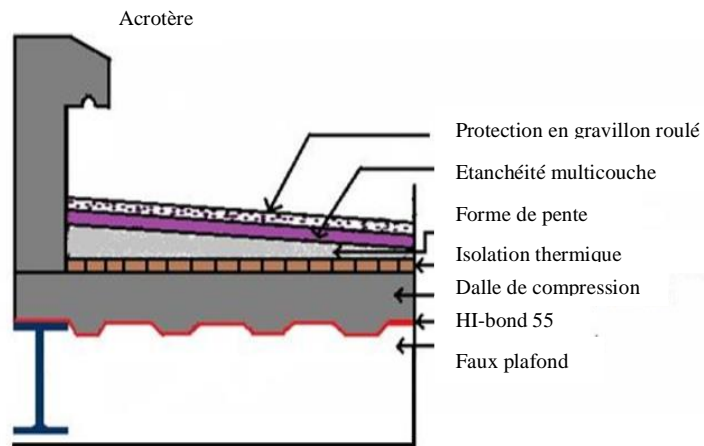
Plancher terrasse inaccessible (PFE-TABET-BOUAYED).
